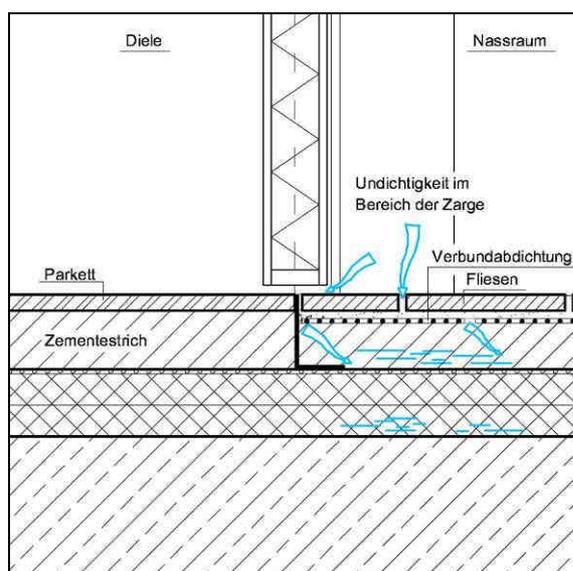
Übergangsbereich zur Diele, Estrich ist durch einen Stellwinkel getrennt.
